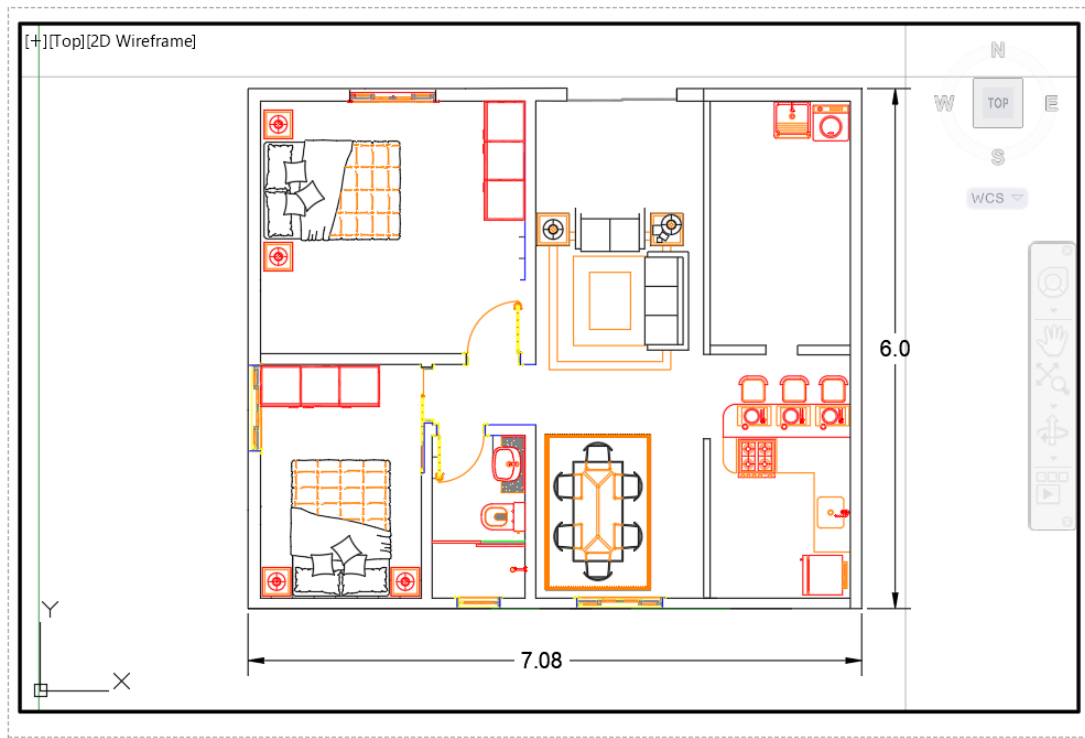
Diseño propuesto para la construcción de la vivienda usando ladrillos ecológicos en la construcción de muros. Fuente elaboración propia del autor.
